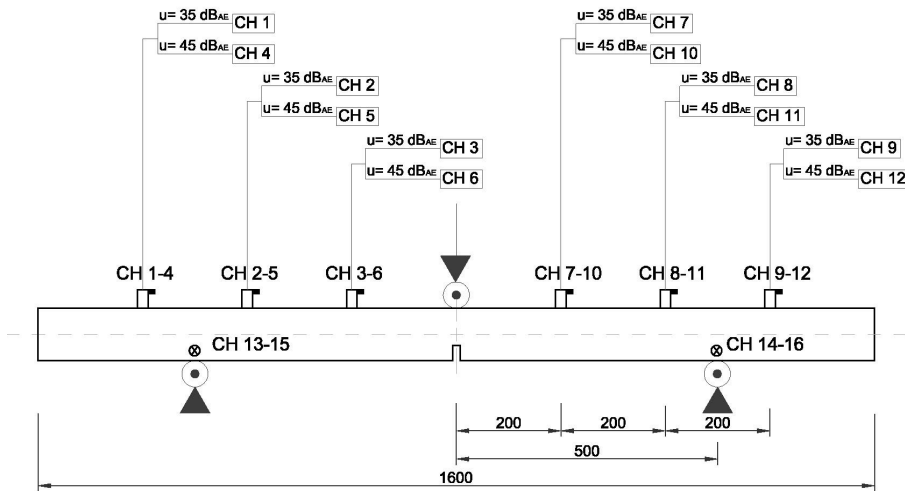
Esquema del ensayo sobre las vigas con muesca.
